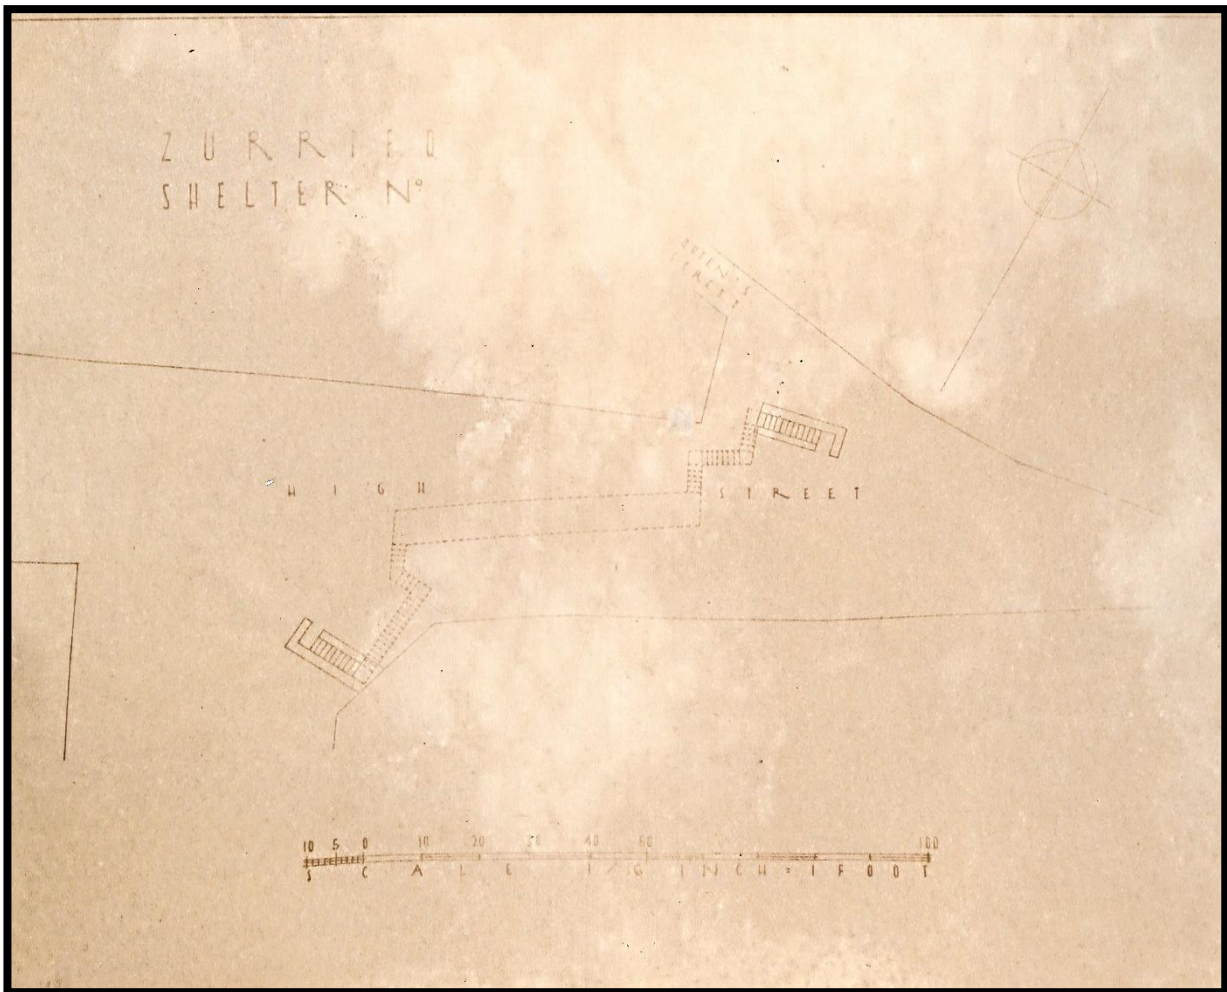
Planta do Abrigo "High Street – Queen's Street"
